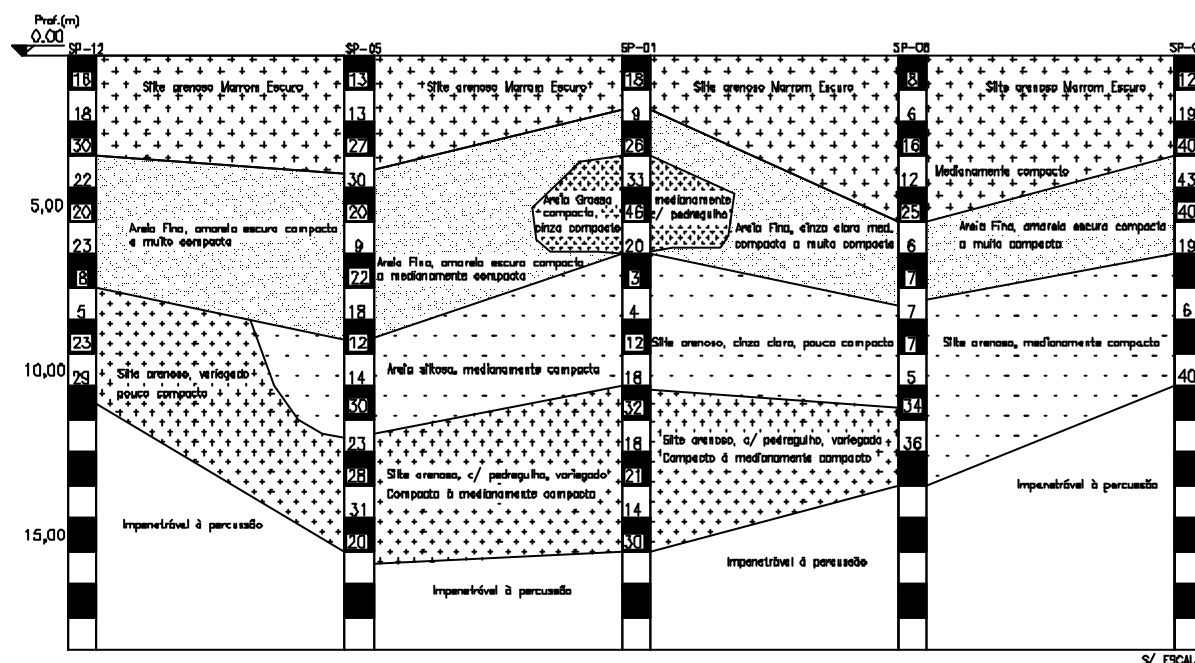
Perfil de Sondagem à Percussão, corte 1-2.
